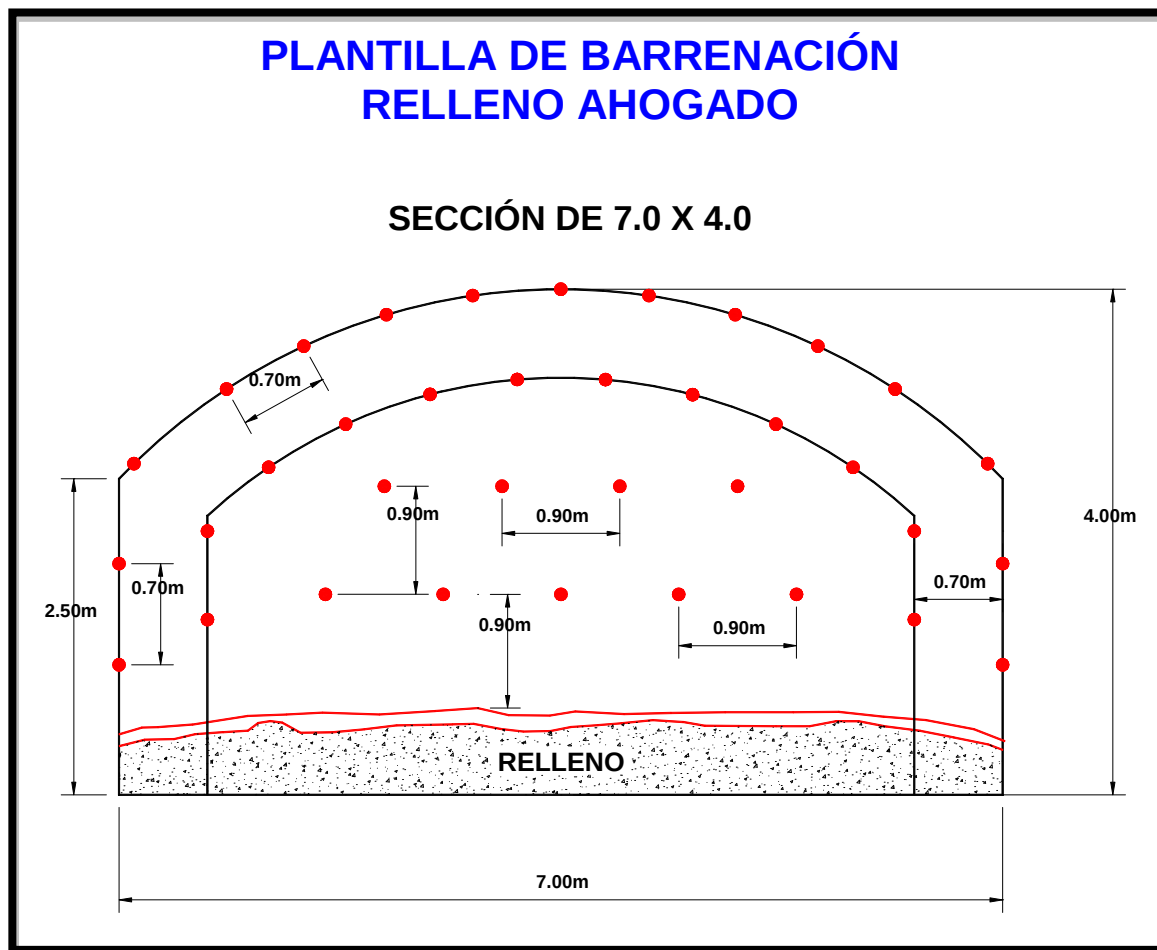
Plantilla de barrenación en bancos horizontales de producción de sección 7 X 4m
